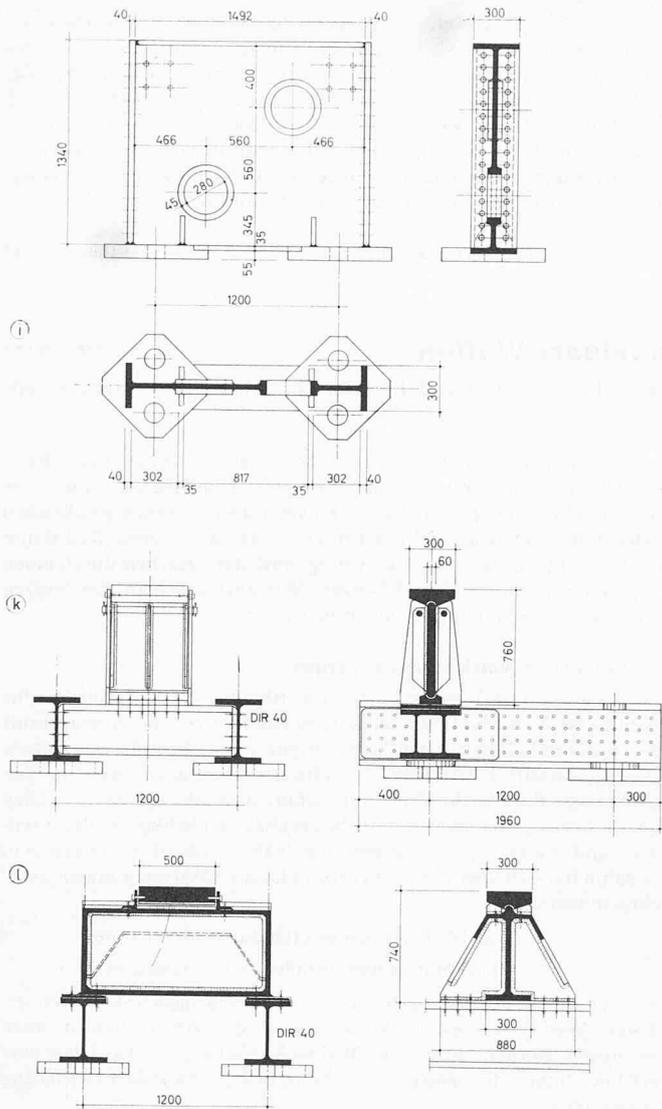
Aufbauten-Einzelteile, Masstab 1:50. i): Bock für Horizontalkräfte; k): bewegliches Lager; l): festes Lager
